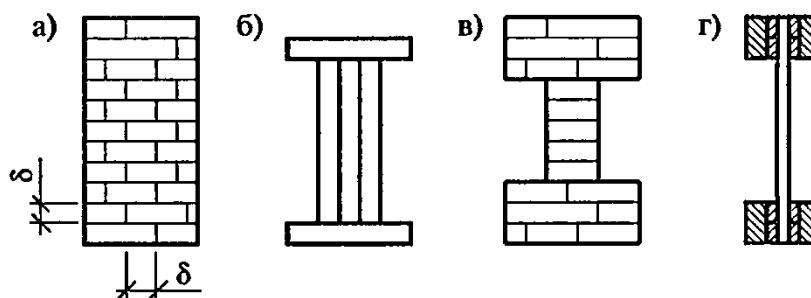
Сечения клееных балок: а) балка из досок, склеенных горизонтально; б) балка из досок, склеенных вертикально и горизонтально; в) балка таврового сечения; г) клееная балка с фанерной стенкой
